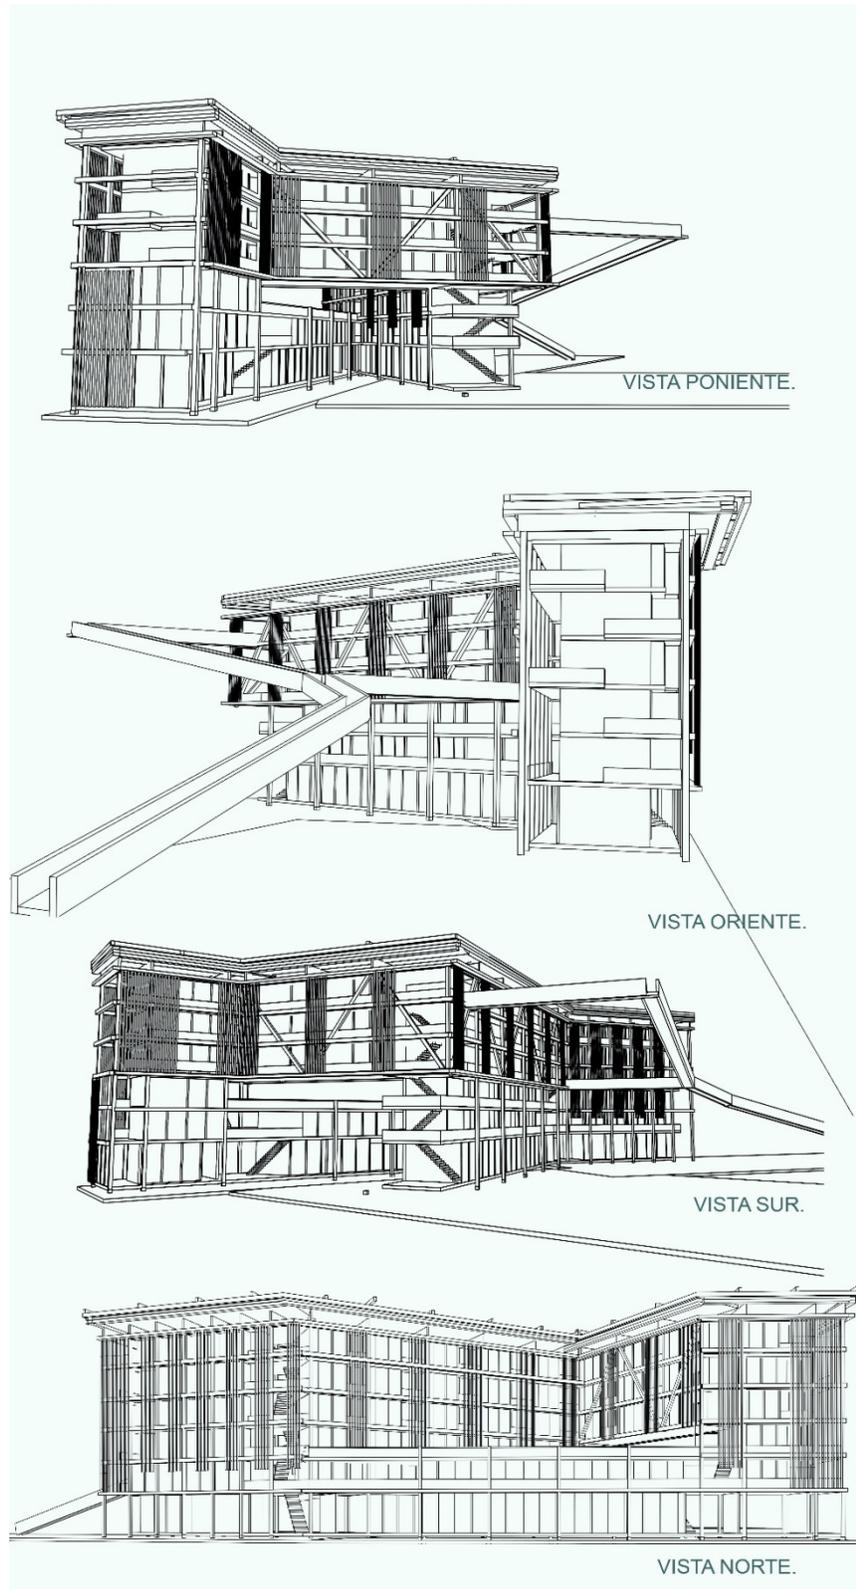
"Vistas de Edificio Boulevard Norte, Sur,
